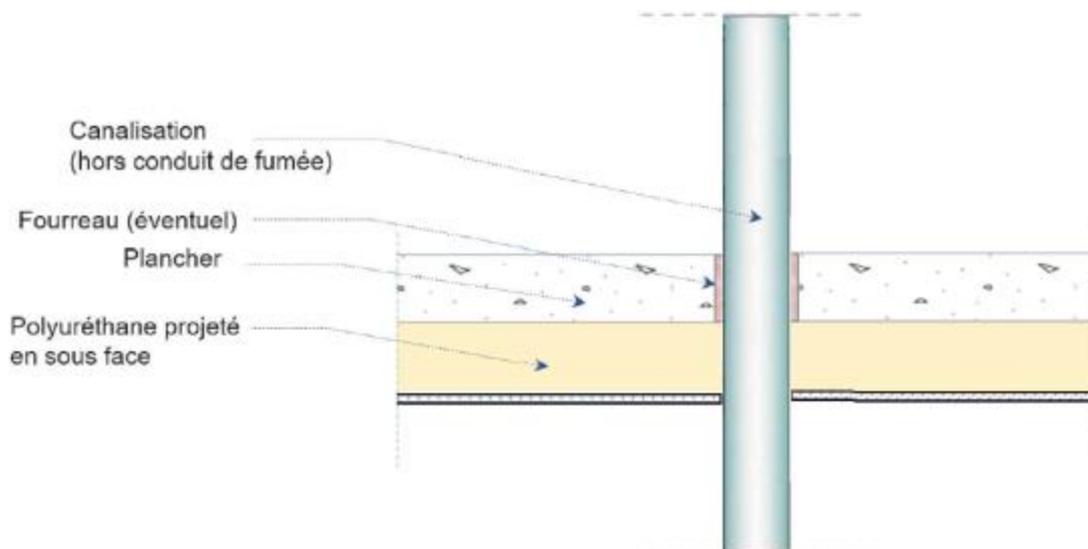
Traitement des éléments traversants (autres que les conduits de fumée)
